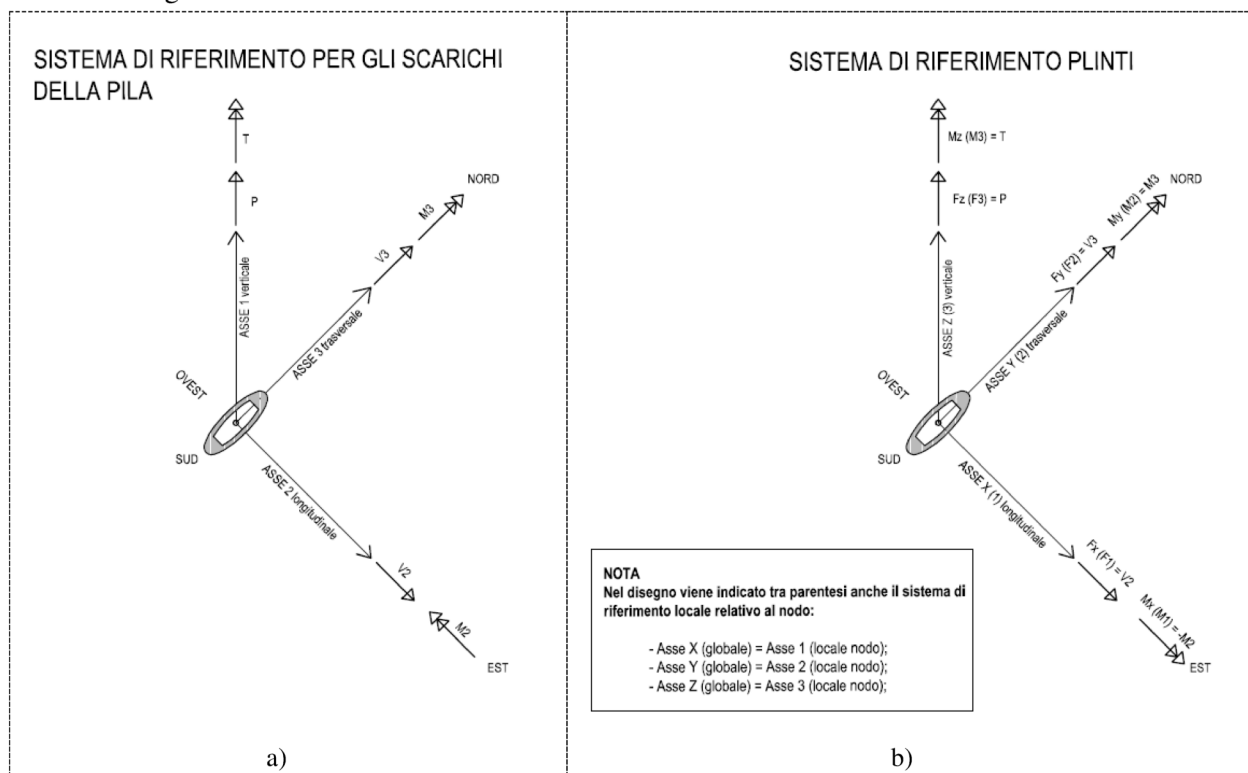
Convenzione scarichi in funzione dei SdR dei modelli di calcolo f.e.m.: a) scarichi trasmessi dalla base della pila a estradosso plinto di fondazione; b) scarichi applicati al plinto di fondazione in corrispondenza del nodo di base della pila.
